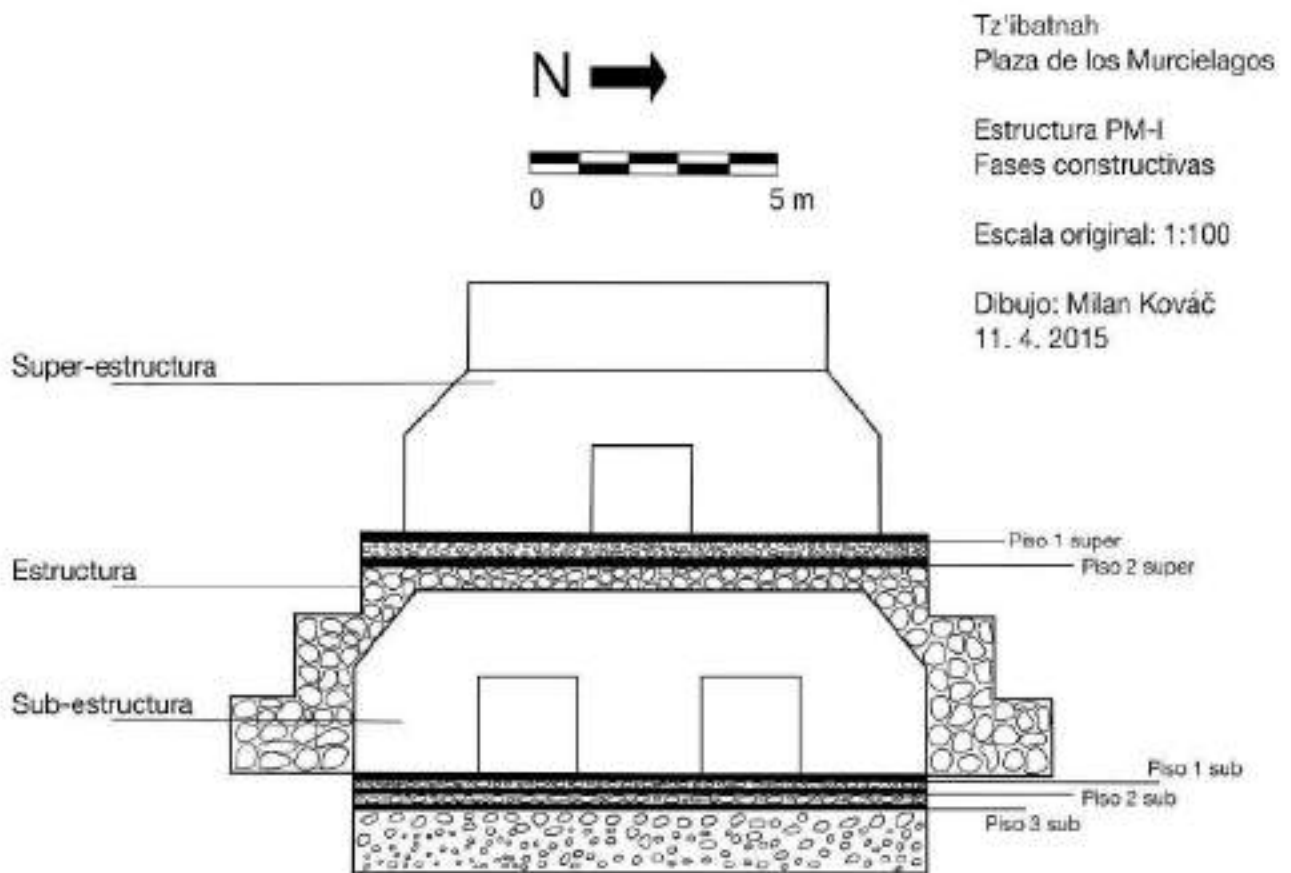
Reconstrucción de la fachada este de la Estructura PM-I.
